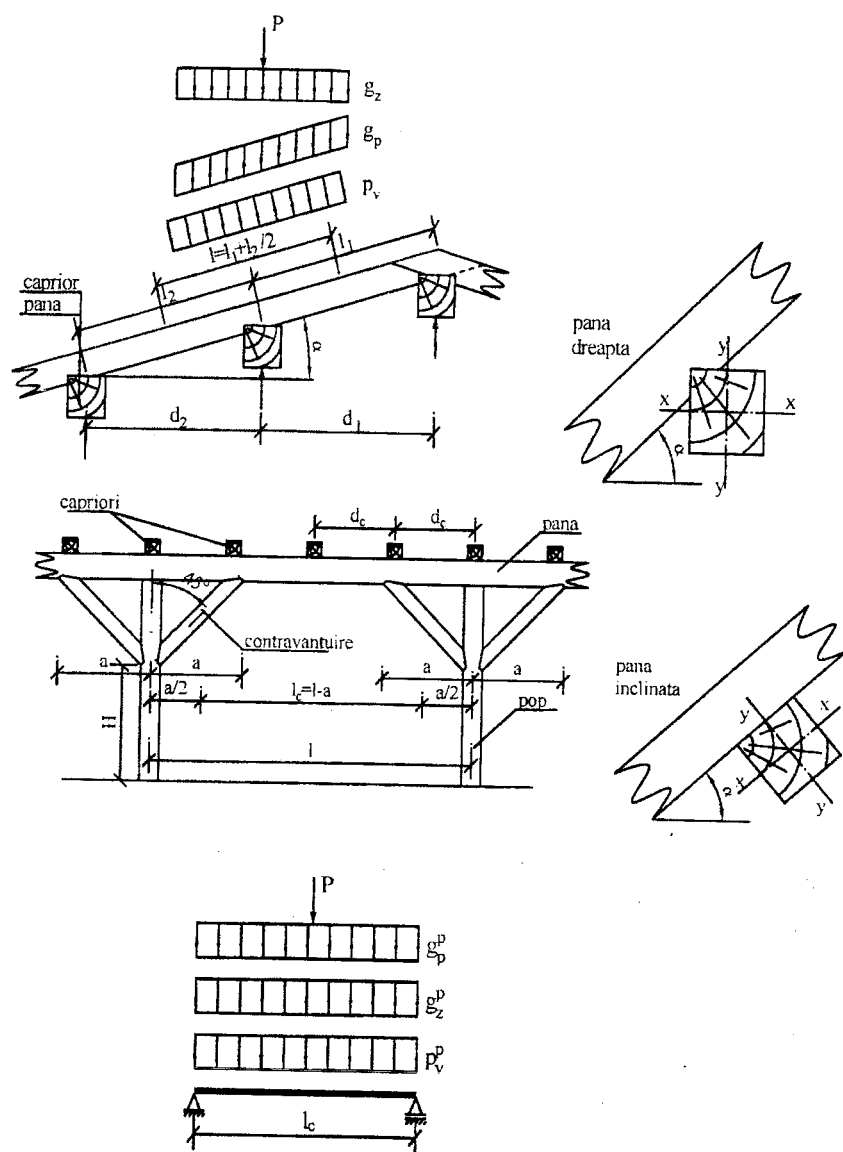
Stabilirea schemei de calcul și a încărcărilor pentru pane
